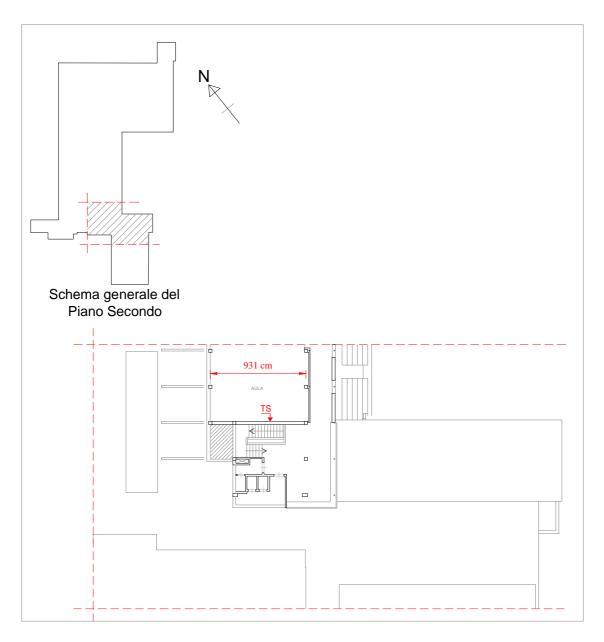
Planimetria schematica del piano secondo dell'edificio.
